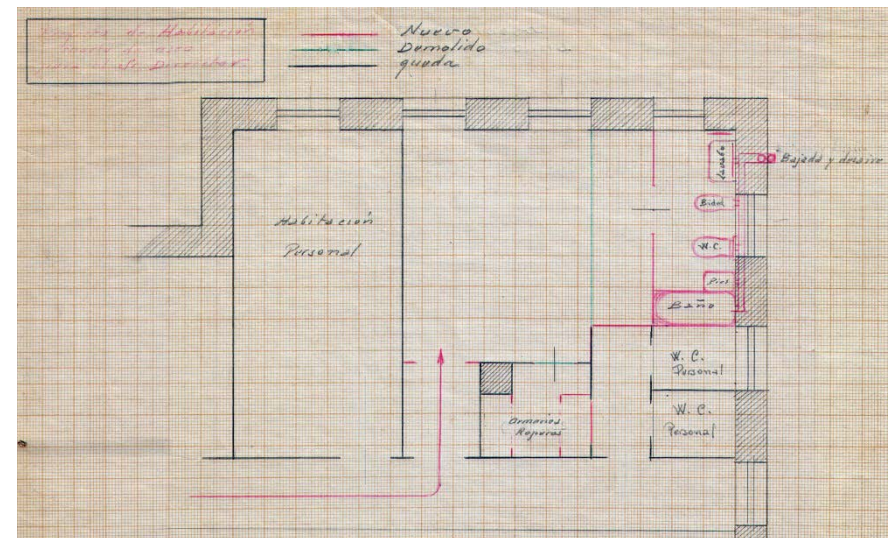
Croquis reforma y construcción de un aseo en segunda planta de Hospedería.<sup>174</sup>
